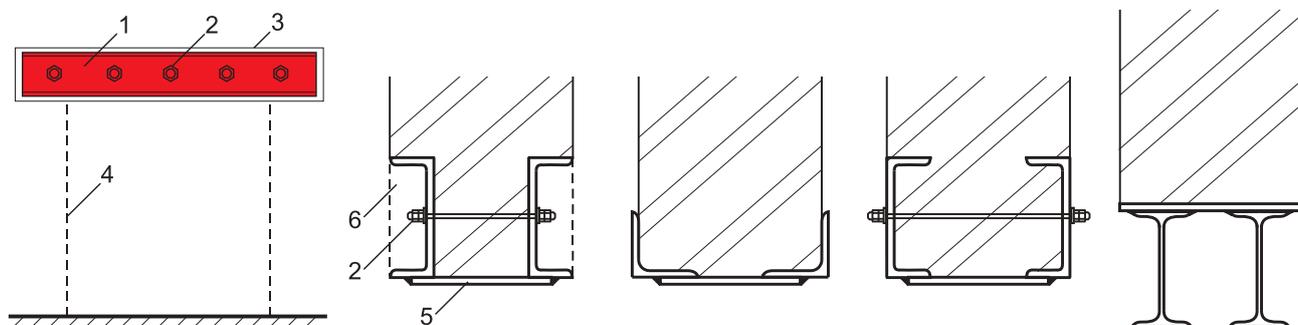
Схемы обустройства перемычек в существующих стенах: внешних – из уголков и двутавров, врезных – из швеллеров; 1 – перемычка из швеллеров; 2 – стяжные шпильки; 3 – штрабы в стене для установки; 4 – проем в стене, устраиваемый после подведения перемычек; 5 – соединительные планки на сварке; 6 – штукатурка по сетке
